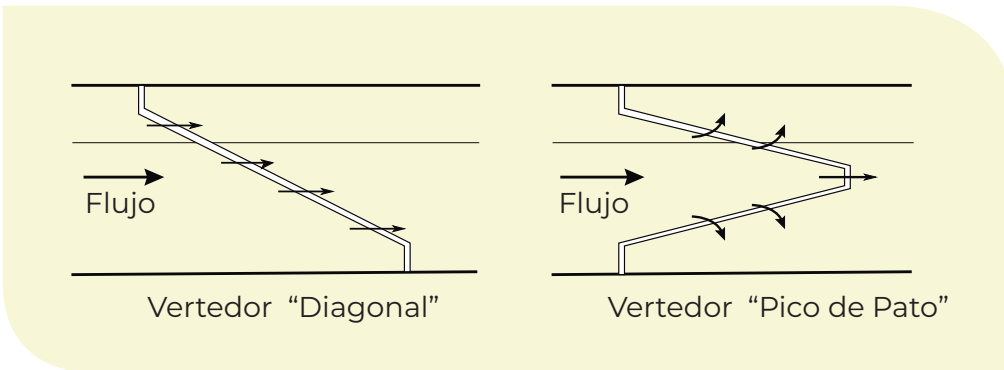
Esquemas de dos vertedores de cresta larga, vistos en planta.
